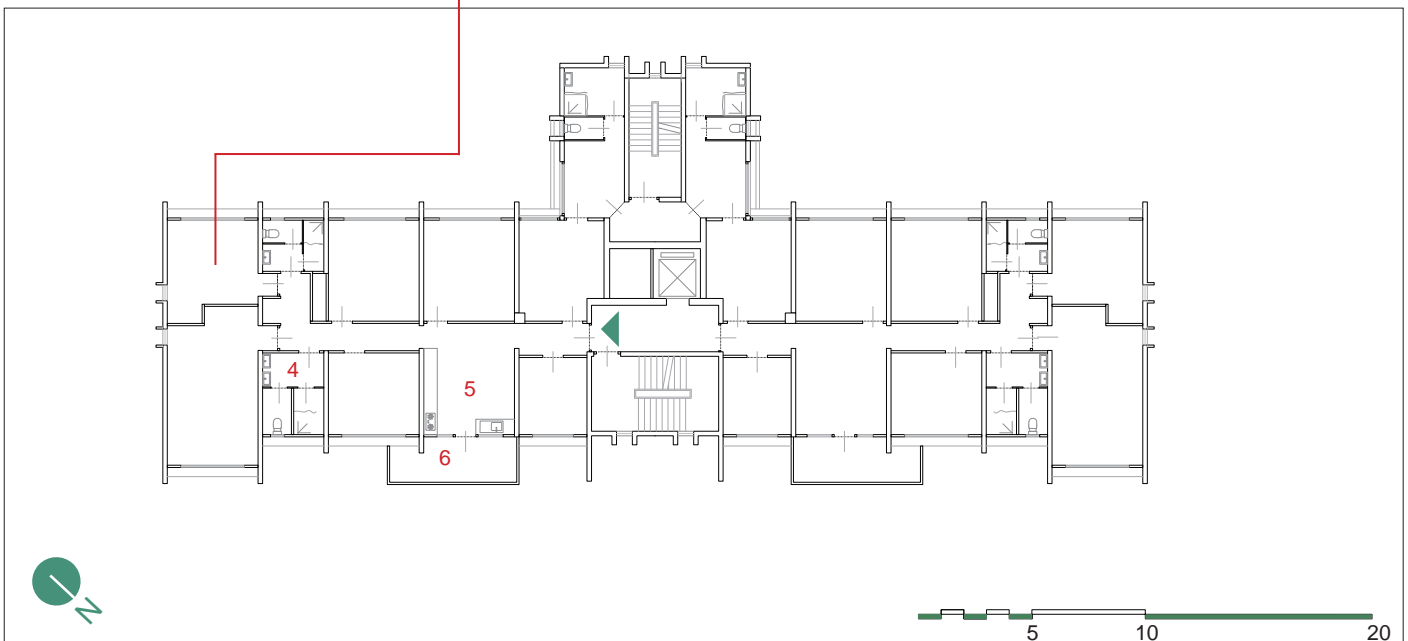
Grundrissplan - Regelgeschoss - I-House 1
